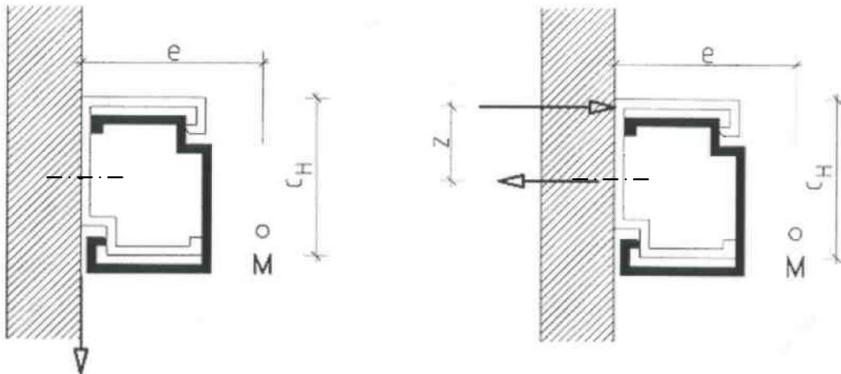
Torsion horizontaler Tragprofile aus Eigengewicht der Fassadenplatte
